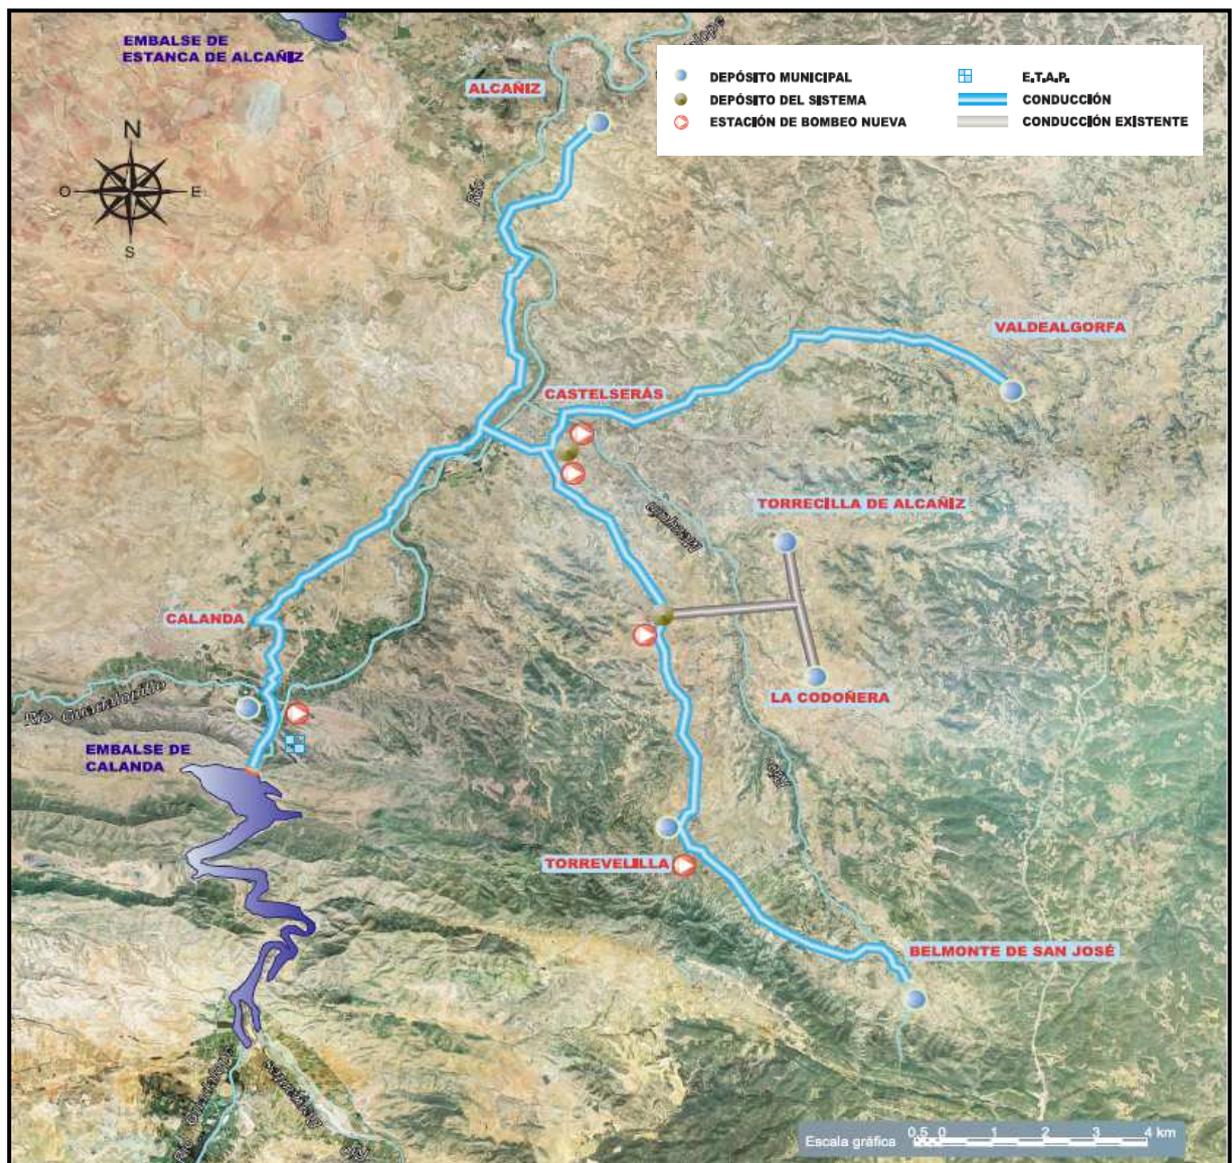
Planta general elementos e infraestructuras del abastecimiento
